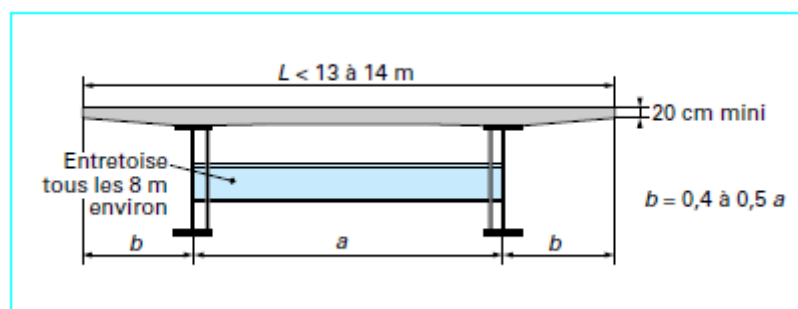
Tablier en bipoutres mixte à entretoise
